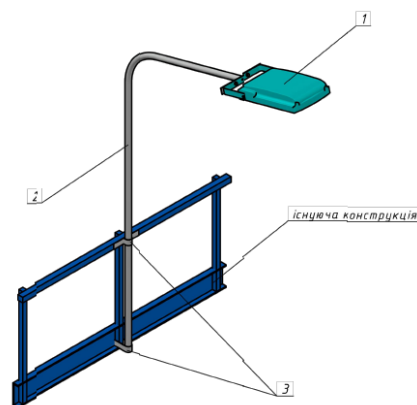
Установка світильників ДТУ18У на фасаді будівлі
